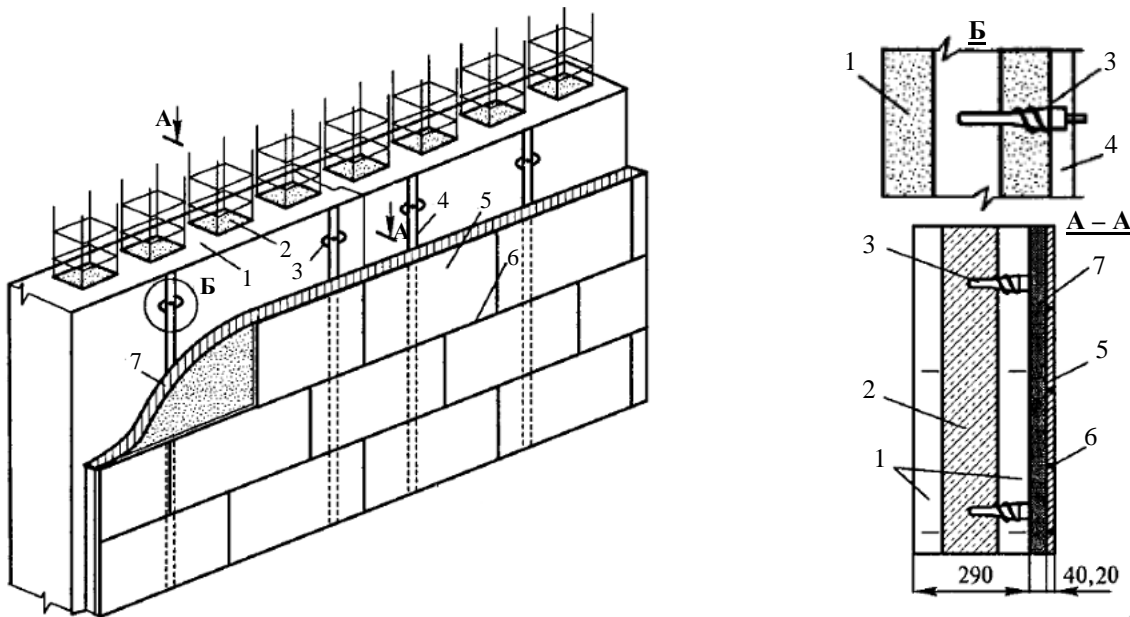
Схема утеплення стін, що зводяться у незнімній опалубці, лічуванням:
